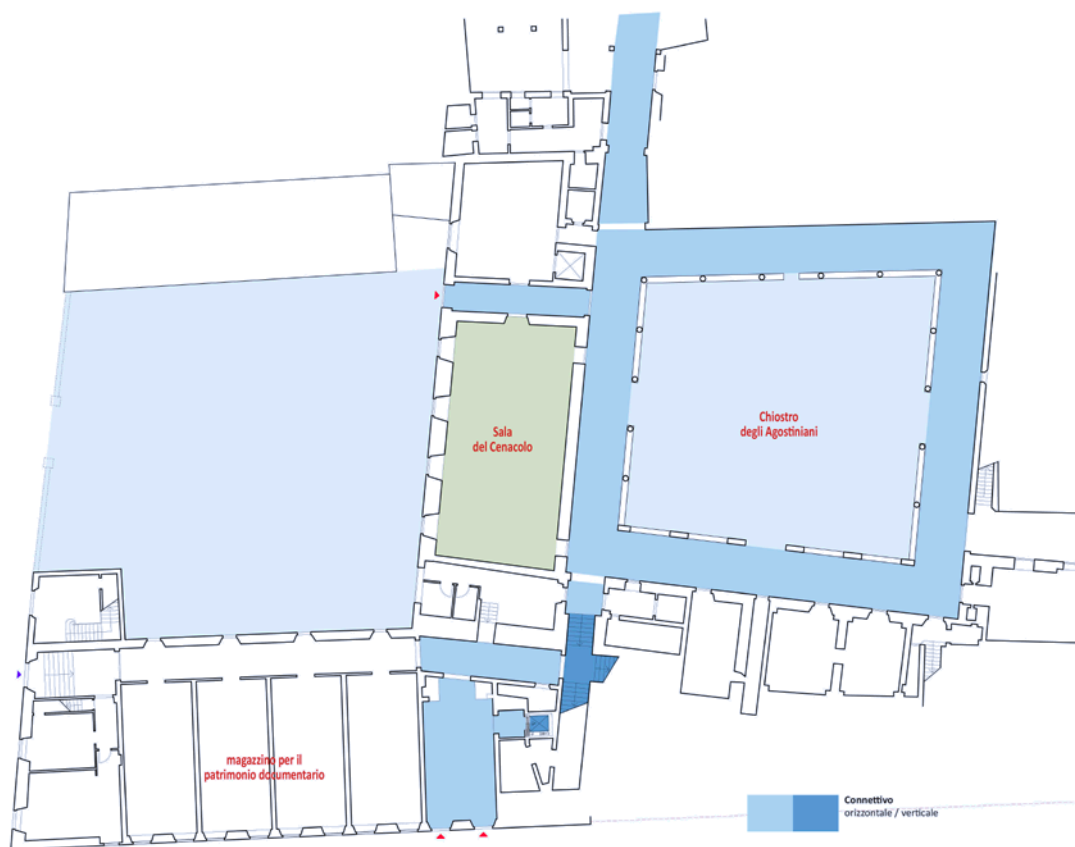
PIANTA PIANO TERRA / TESSUTO CONNETTIVO
